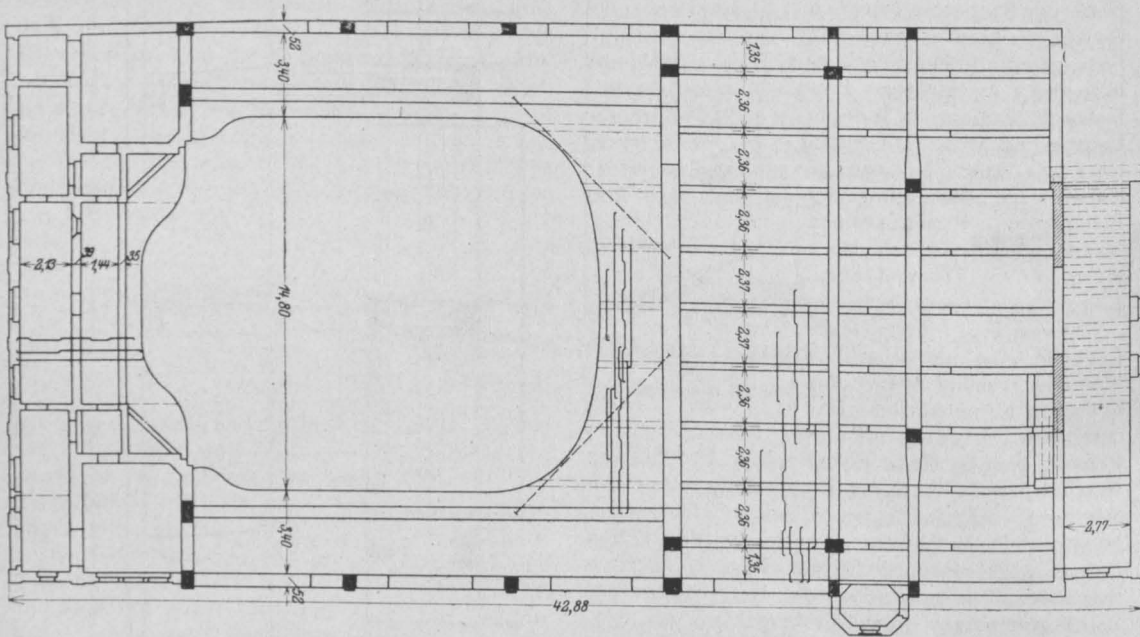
Grundriß des Theatersaales mit Galeriedecke.
